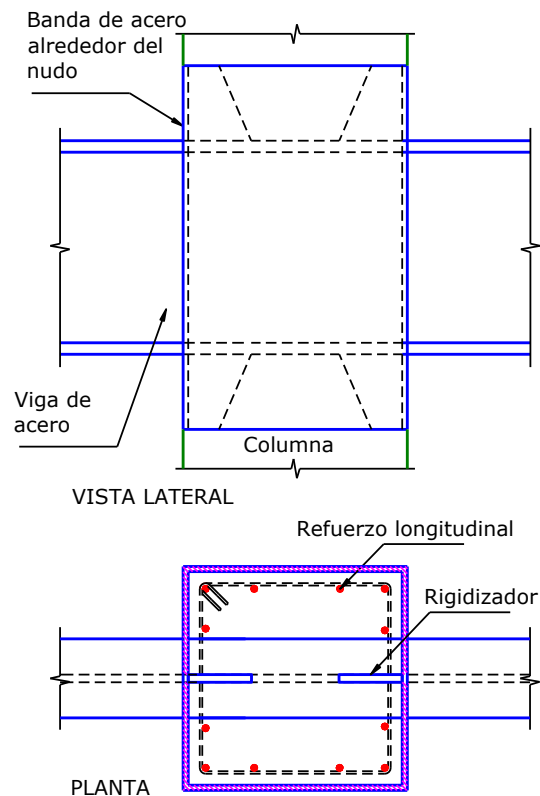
Conexión viga de acero-columna de hormigón armado con banda de acero que rodea completamente al nudo.
